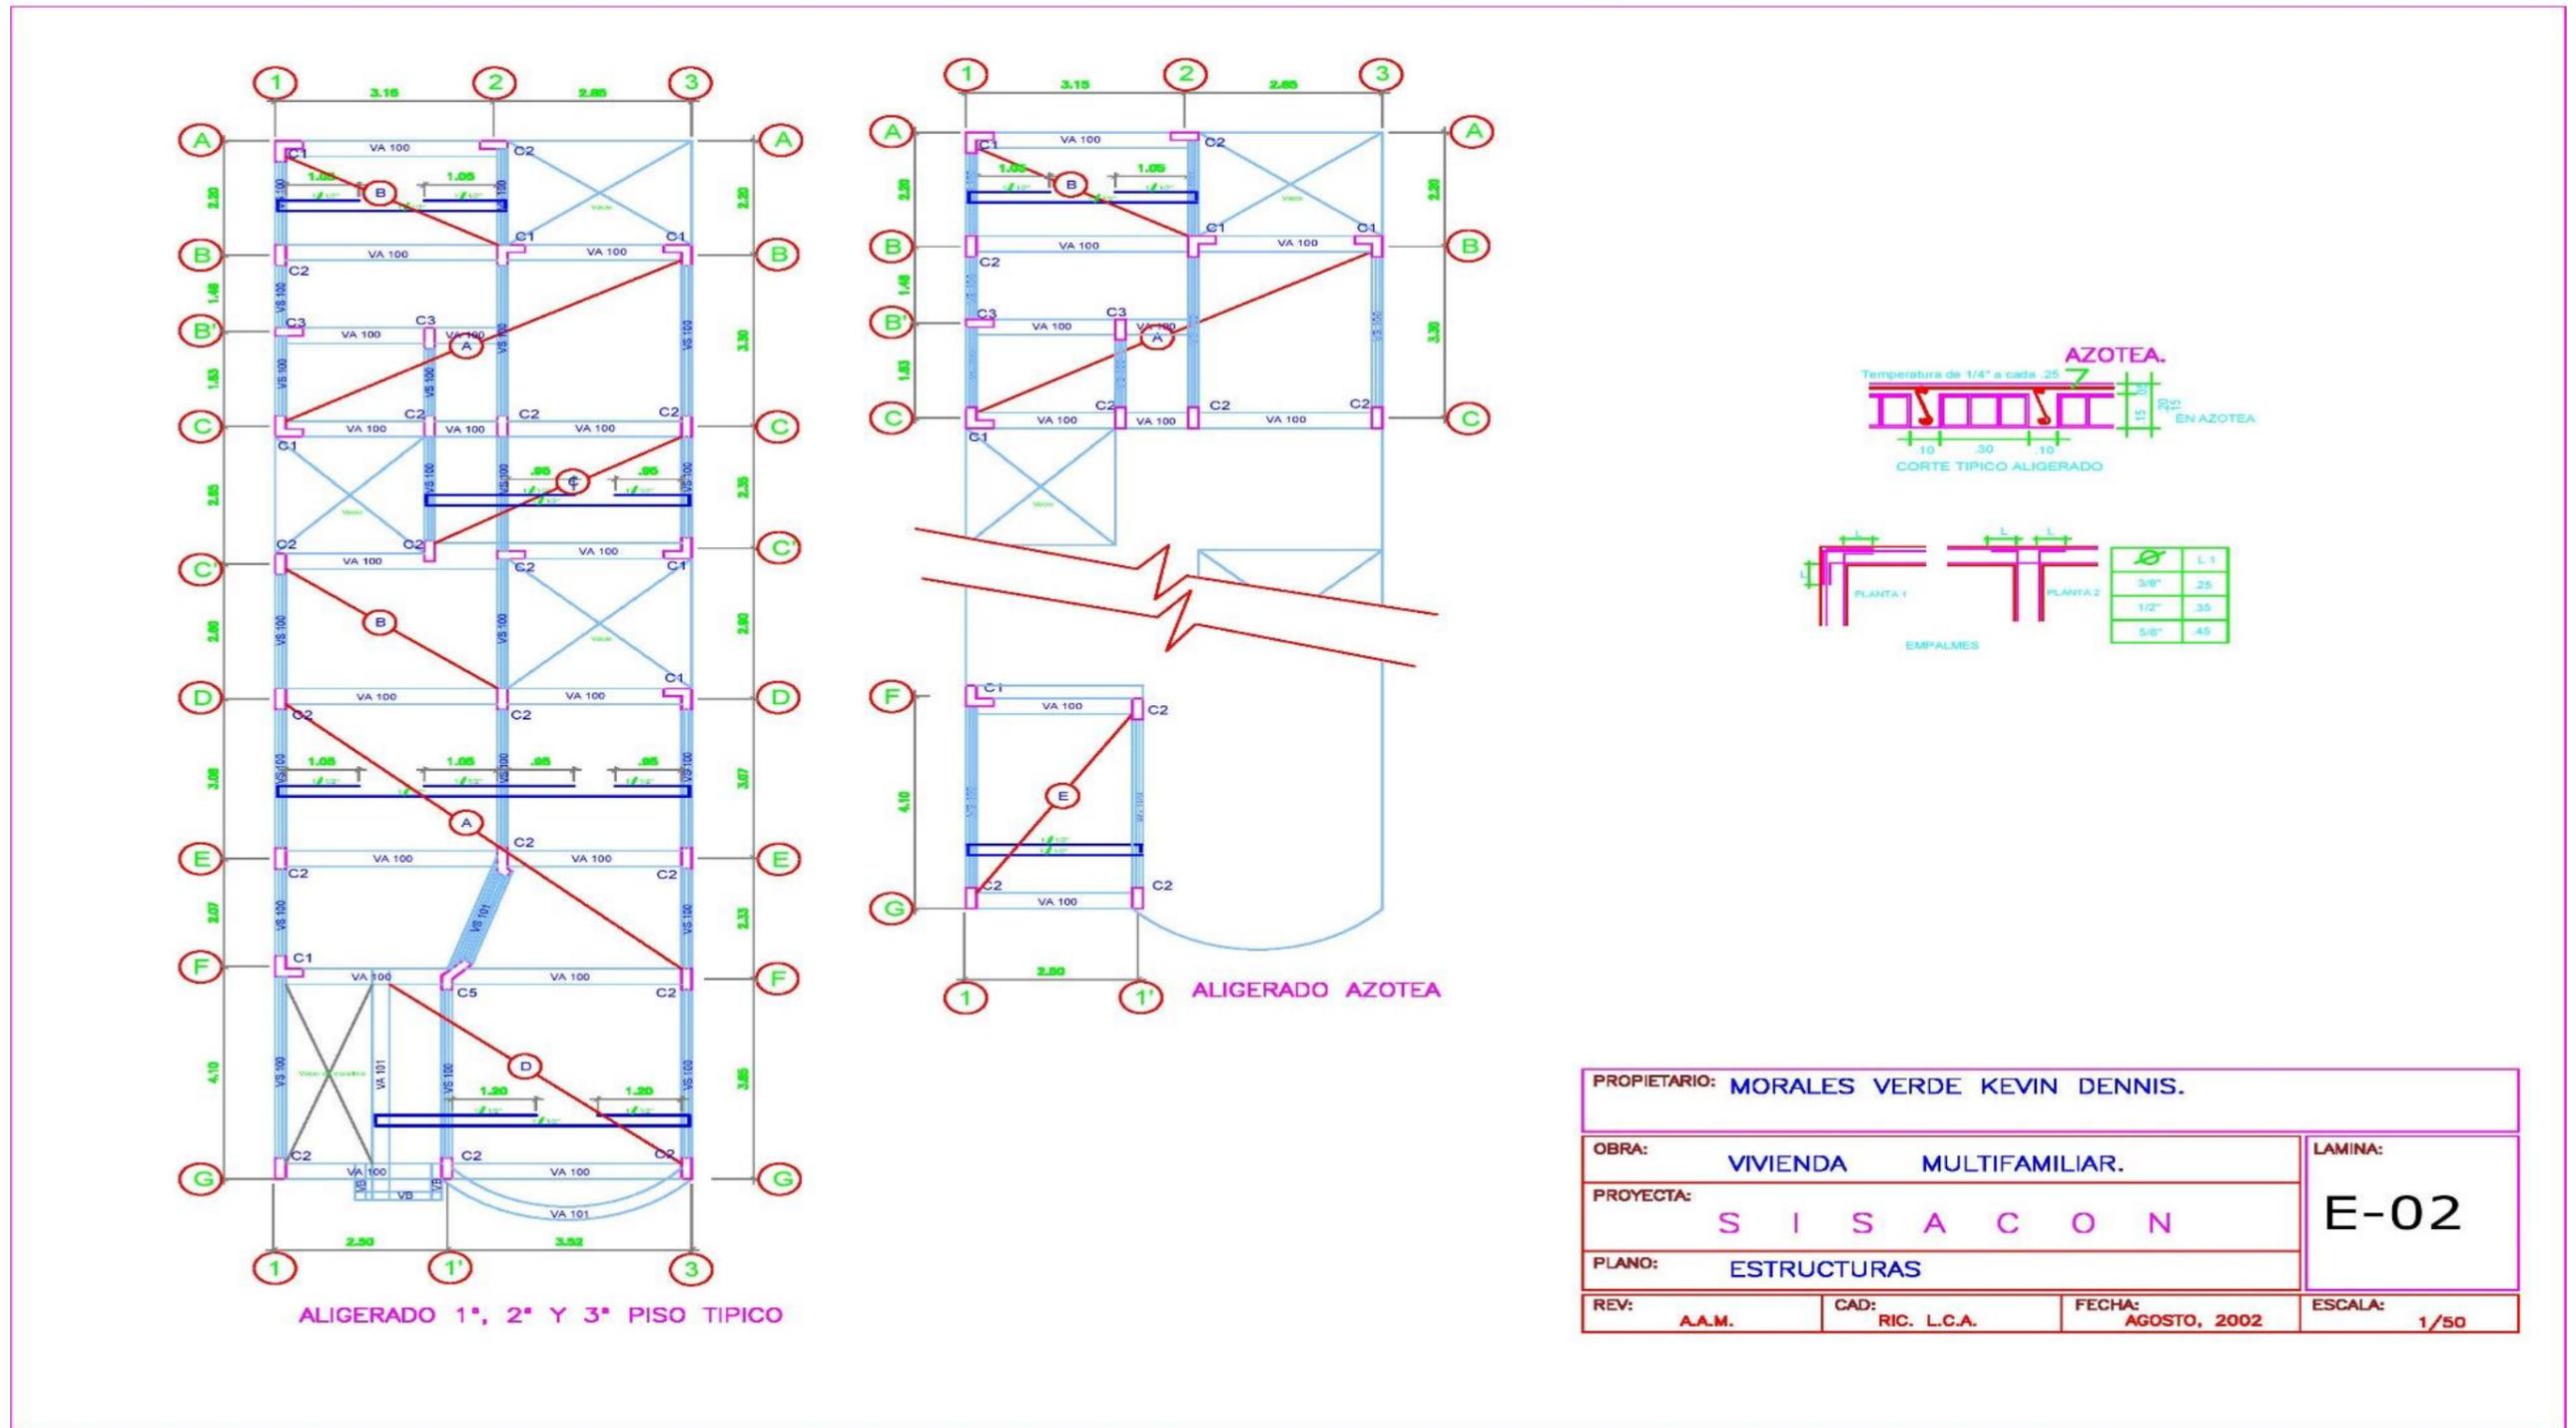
Plano de vivienda Av. German Aguirre N° 1742- San Martin de Porres
